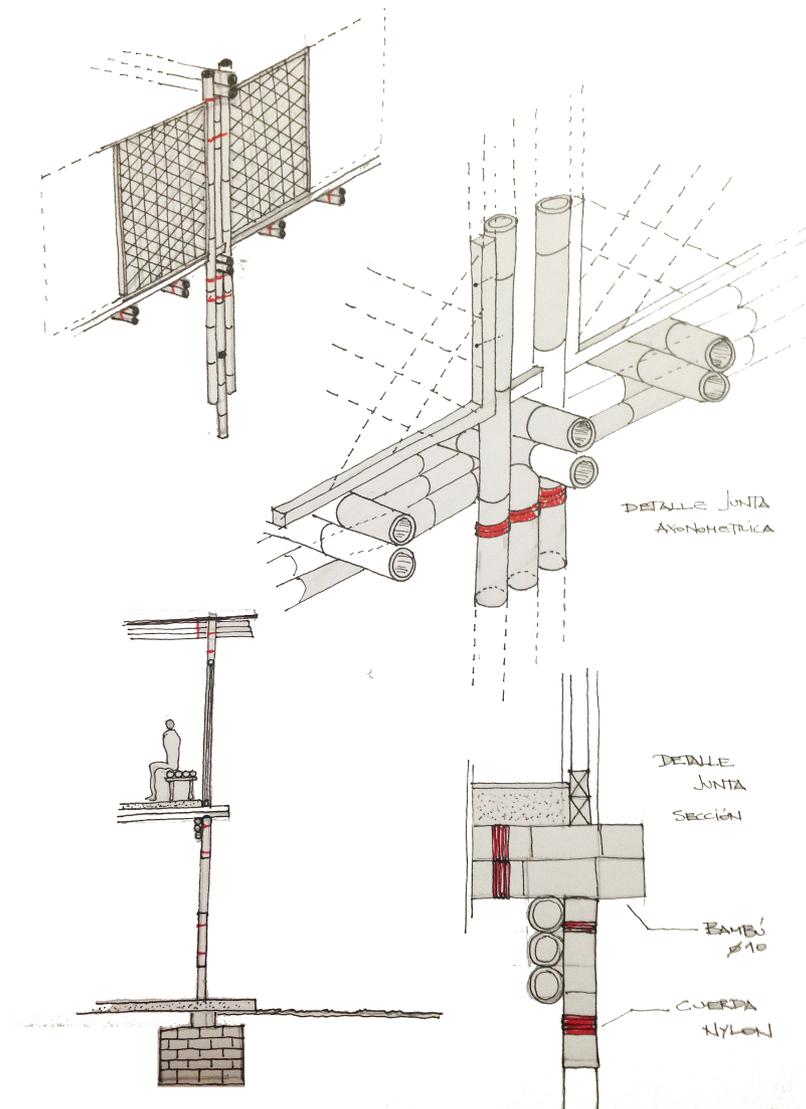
Boceto en el cual se muestra el armado de las columnas con las vigas en la zona del hall. (Fuente: Elaboración Propia)
